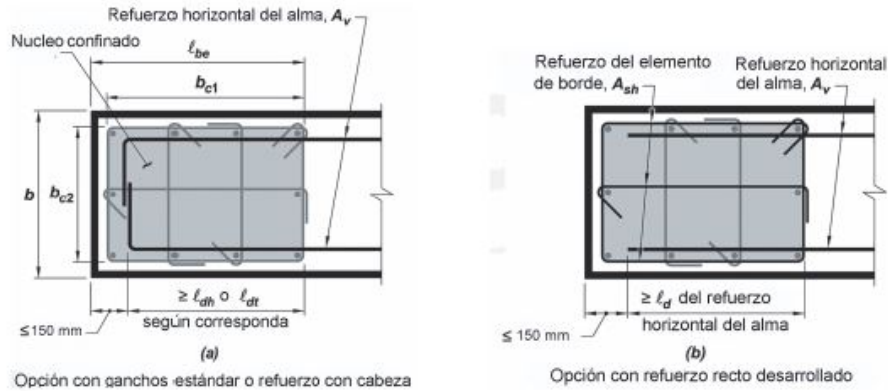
Desarrollo del refuerzo horizontal del muro dentro del elemento confinado de borde
